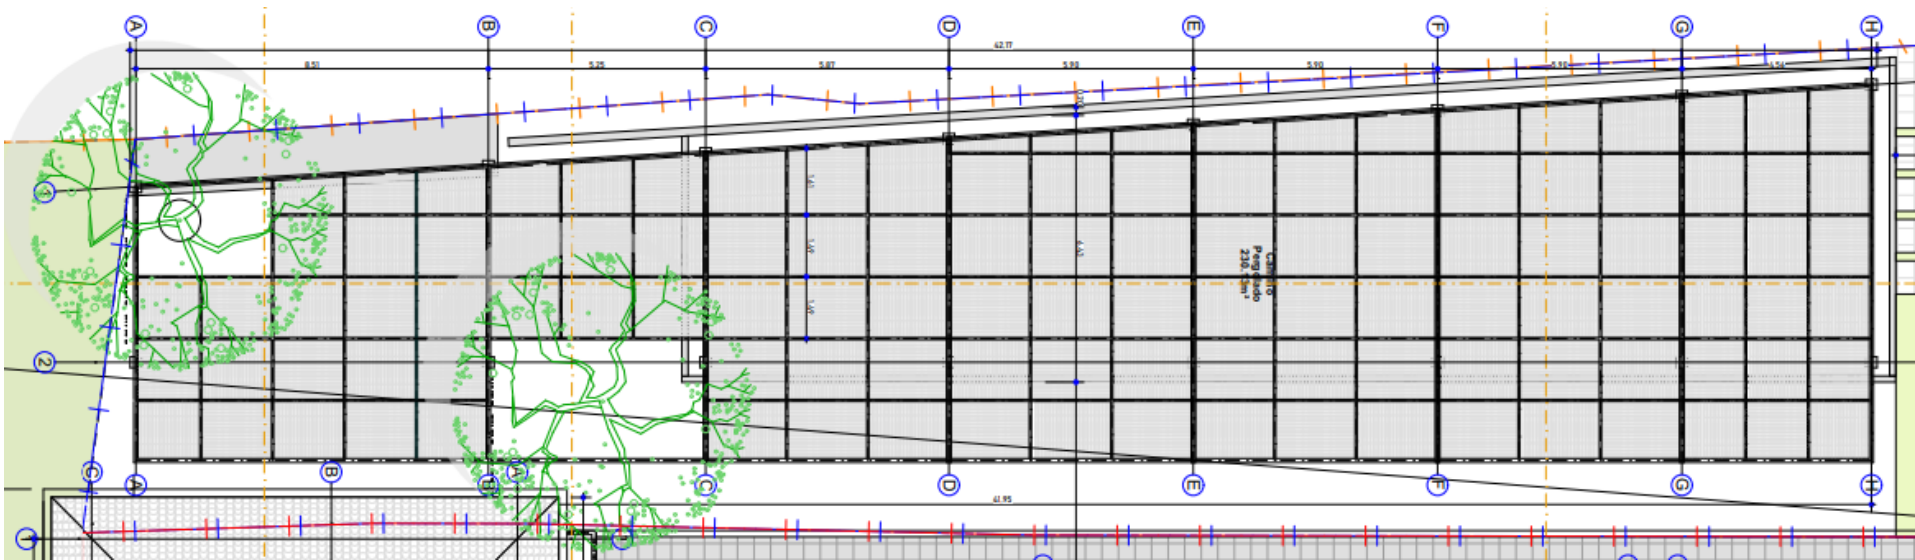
Vista en planta del camino pergolado del Plano Arquitectónico. Fuente Constructora sueños reales.
